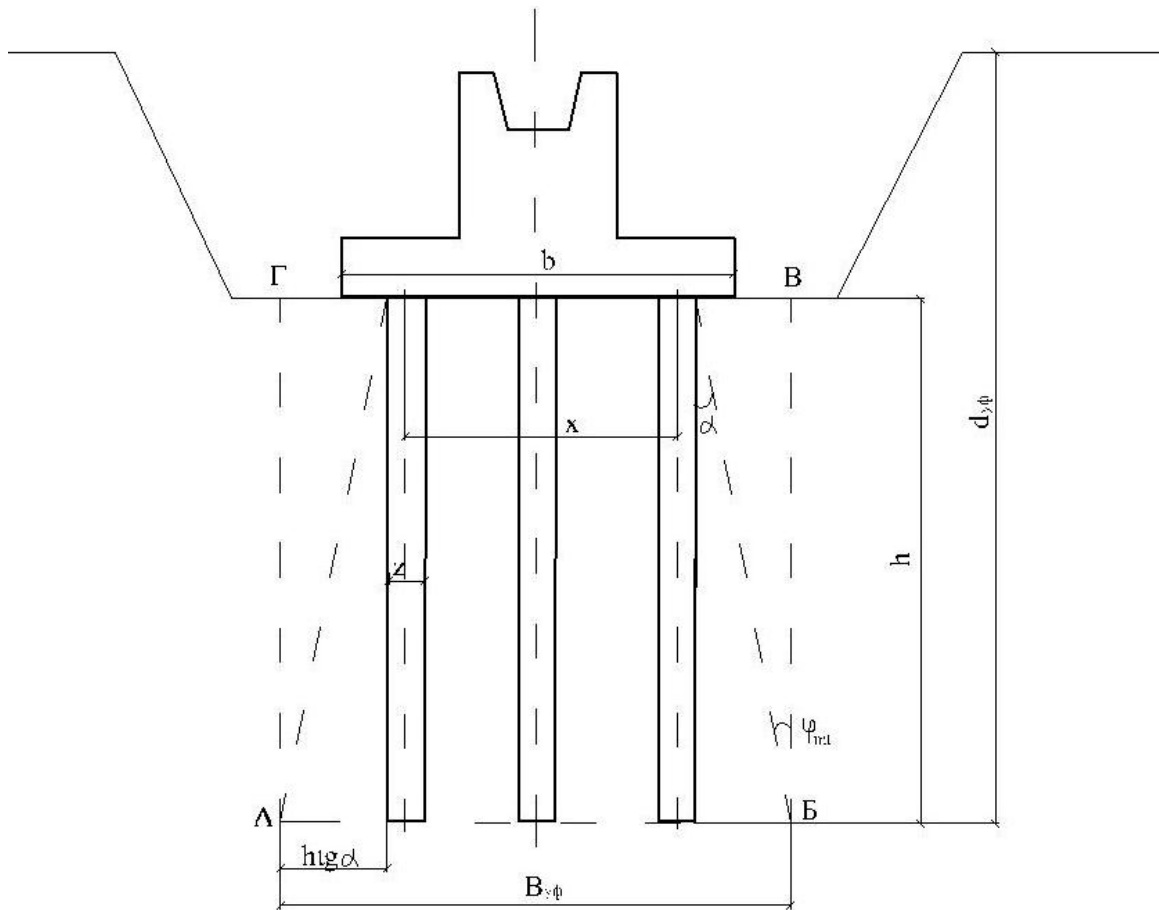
Розрахункова схема пального фундаменту за деформаціями
